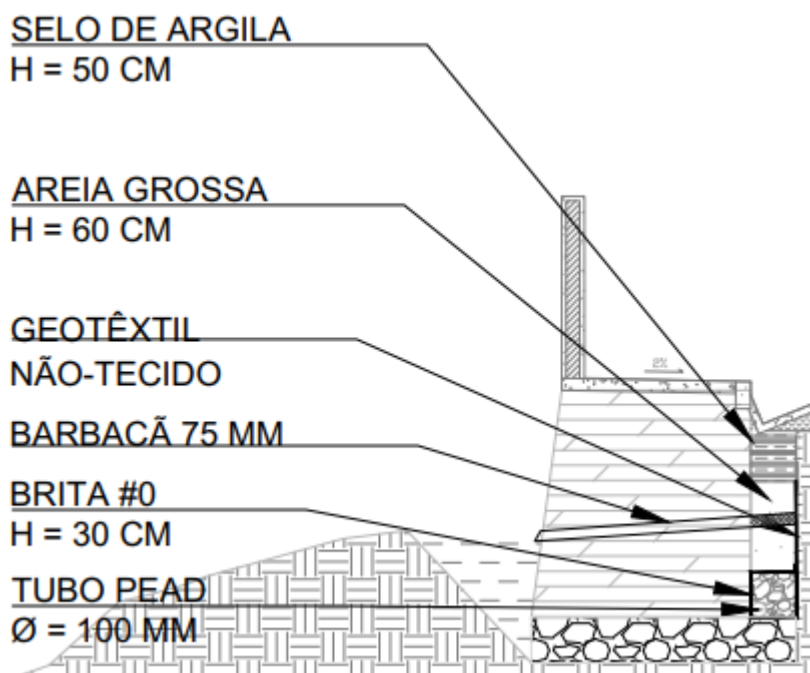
Corte esquemático de drenagem - solo-cimento ensacado
